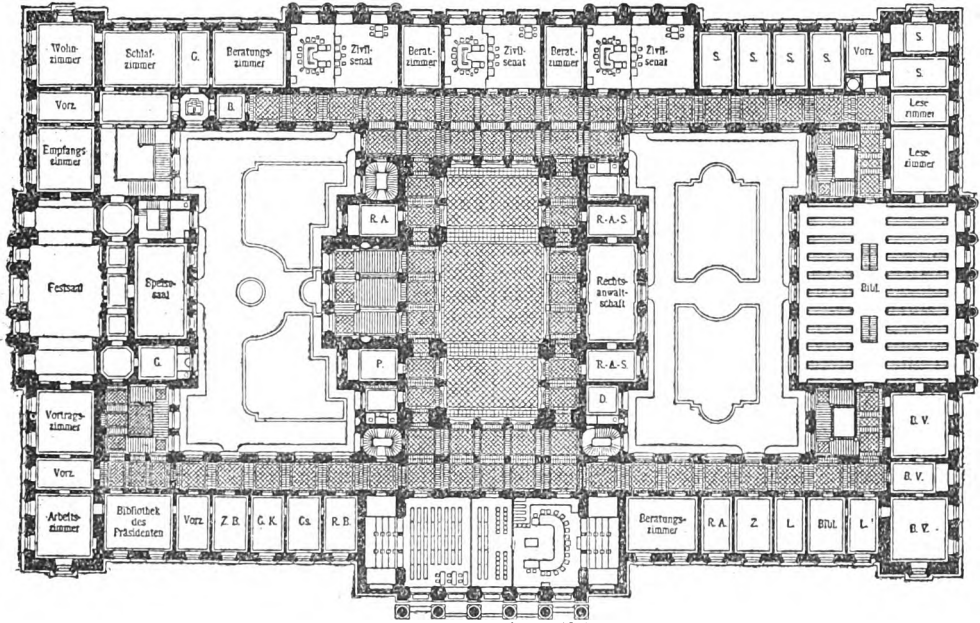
Reichsgerichtsbau. Grundriß des obern Hauptgeschosses.
